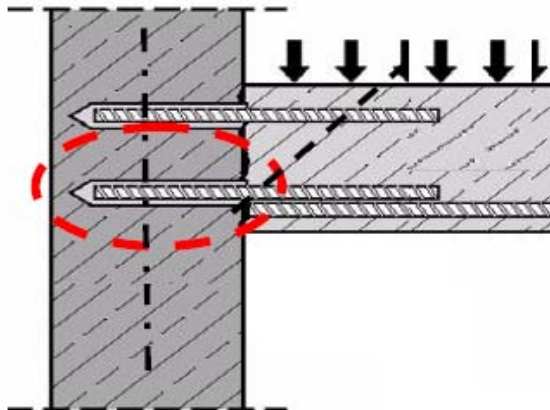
Vista schematica collegamento inghisaggi post-istallati
